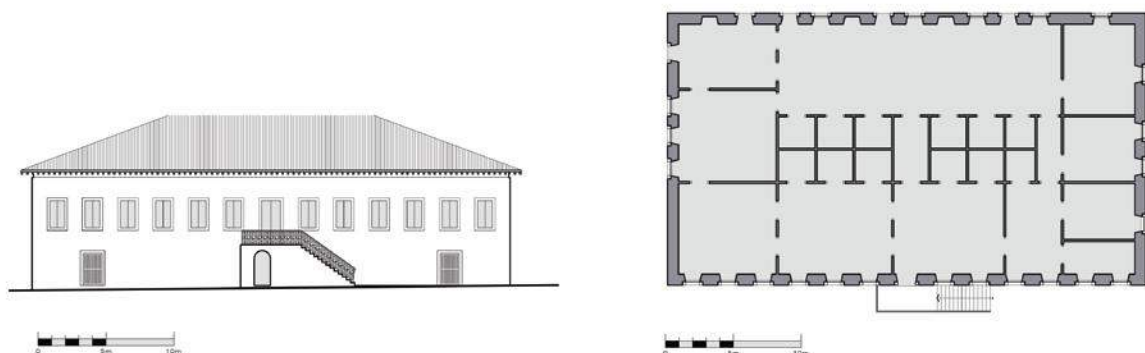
Fachada e Planta da casa-grande do Engenho Tatu (c. 1820).
